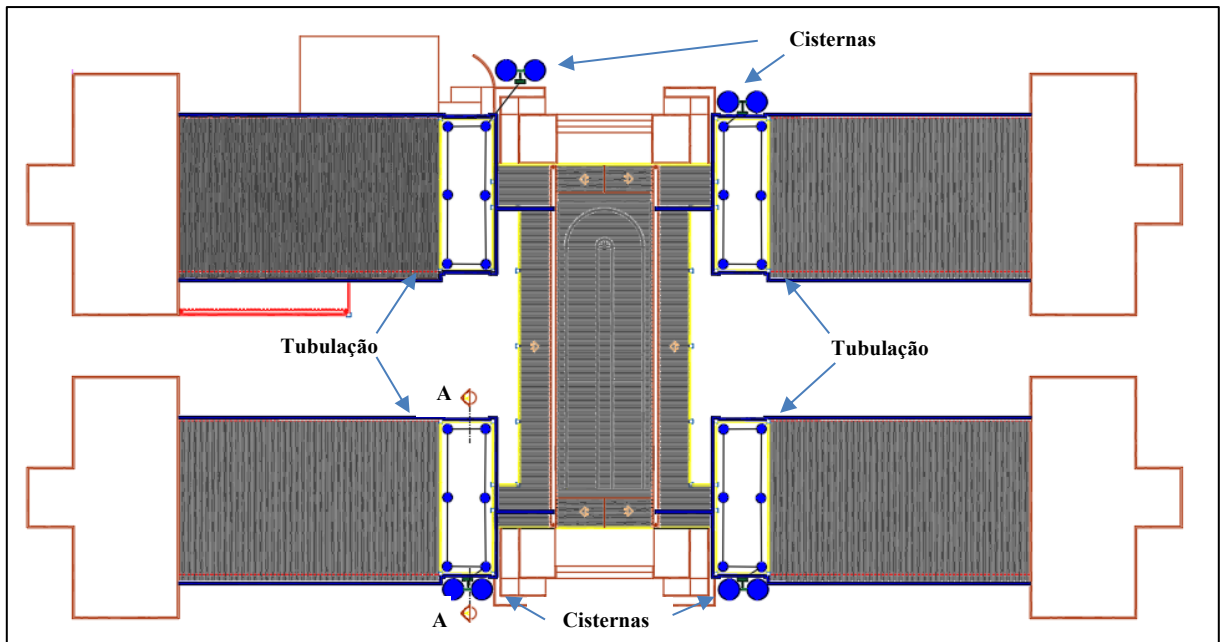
Caminhamento da captação de águas pluviais -vista das instalações horizontais, verticais e dos reservatórios
